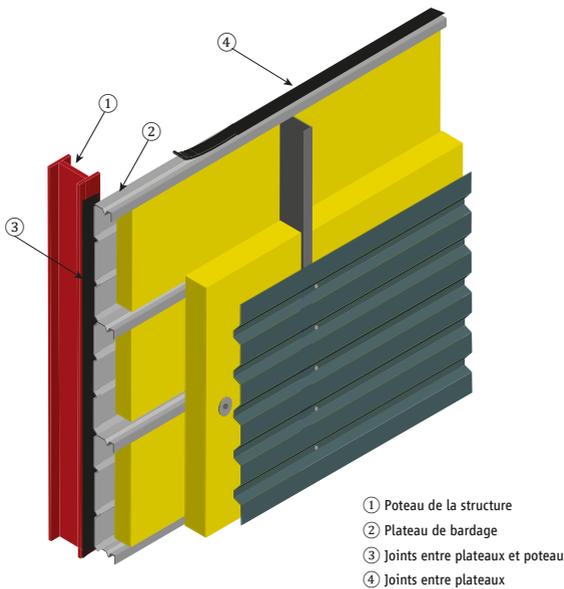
Traitement de la perméabilité à l'air par joints adhésifs entre plateaux et entre plateaux et structure
